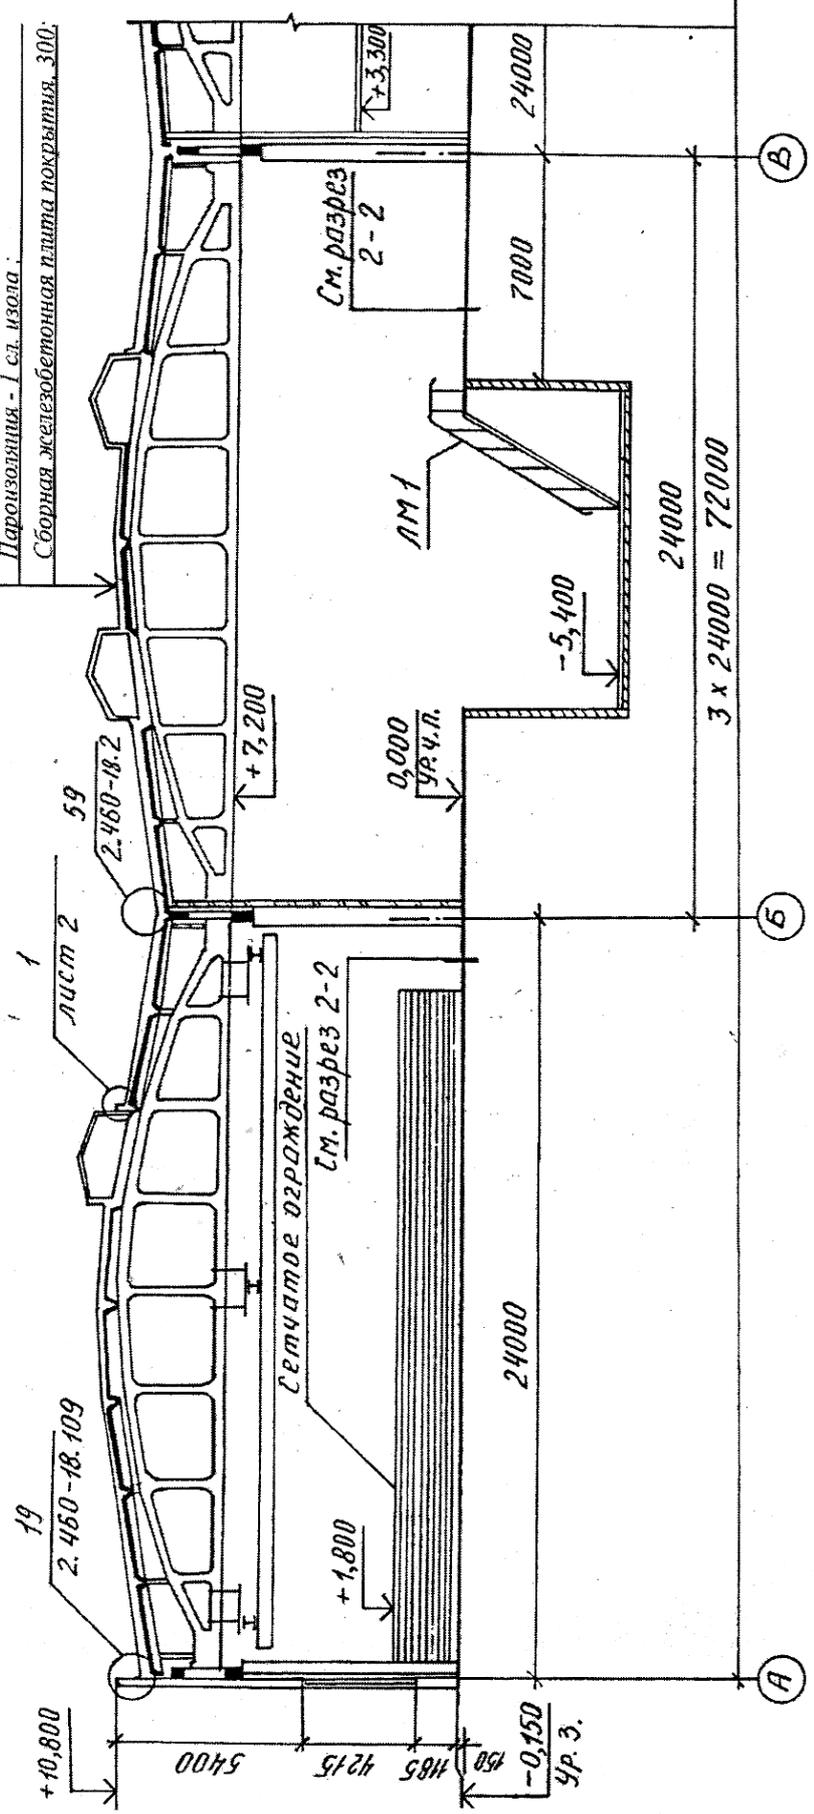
Пример выполнения поперечного разреза производственного здания с безраскосной железобетонной сегментной фермой и зенитными фонарями
